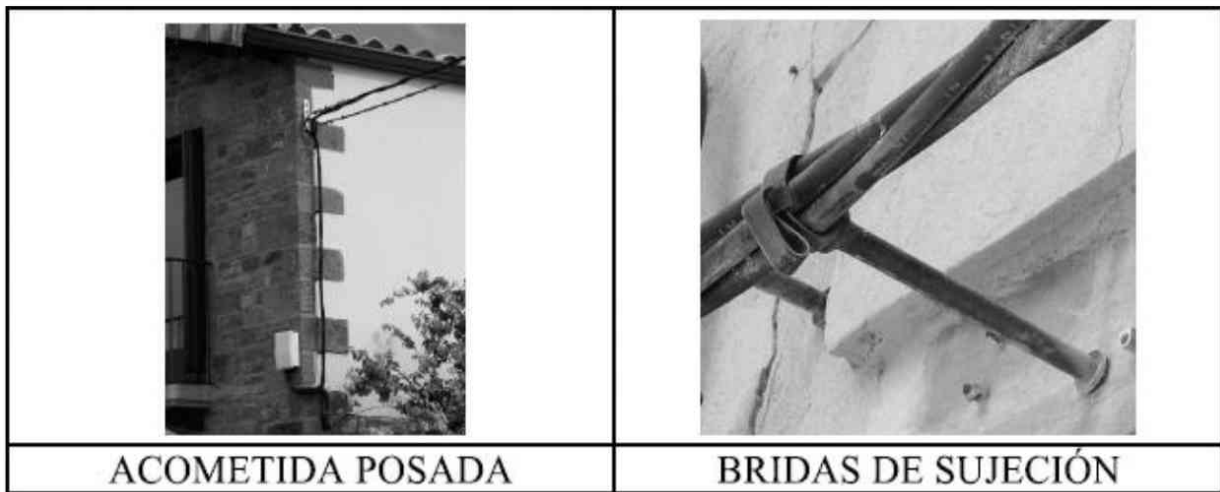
Detalles de acometidas posadas sobre fachada
